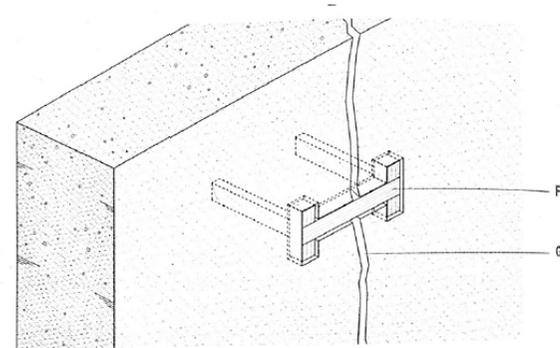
Detalle constructivo. Fuente: Carlos Fuster Aparisi.
